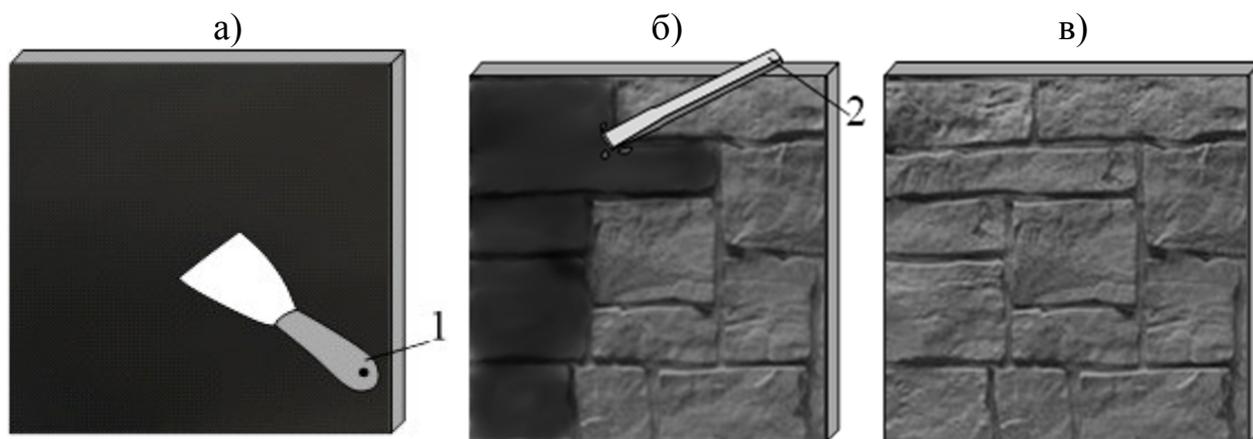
Наковка каменной штукатурки «под рваный камень»: а – нанесение накрывочного слоя; б – наковка камней или рустов; в – готовая штукатурка; 1 – шпатель; 2 – зубило
